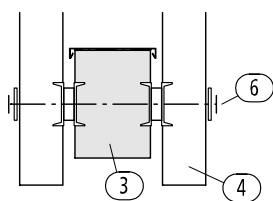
Befestigung mit So-Nägeln oder Schrauben
